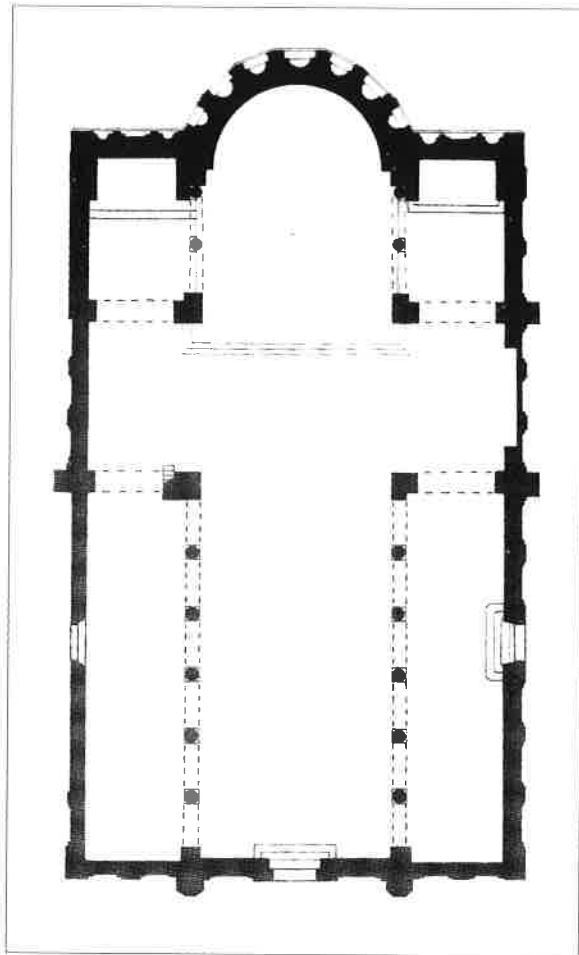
Murano, Chiesa dei Santi Maria e Donato, pianta.
